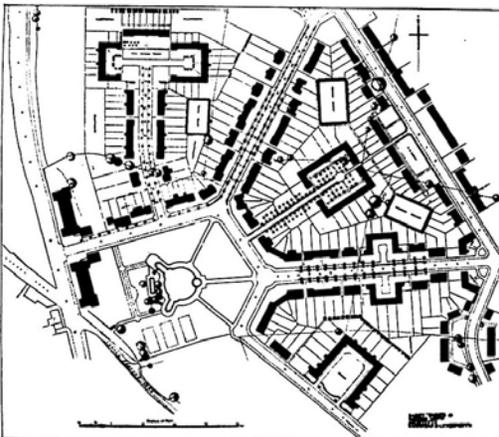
Hampstead: plaza de acceso en Fichley Road.
